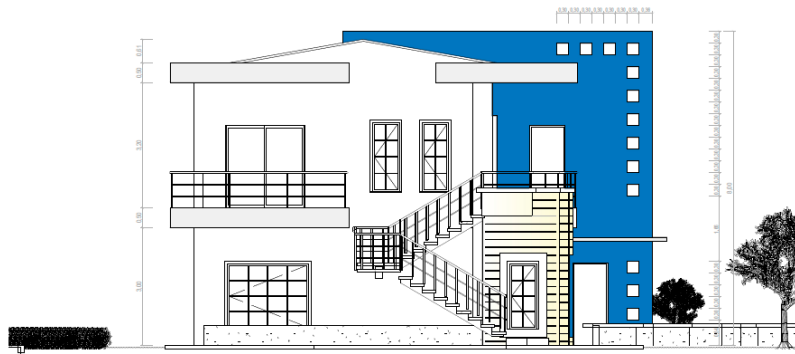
Fachada Norte Actual Cafamaz.
